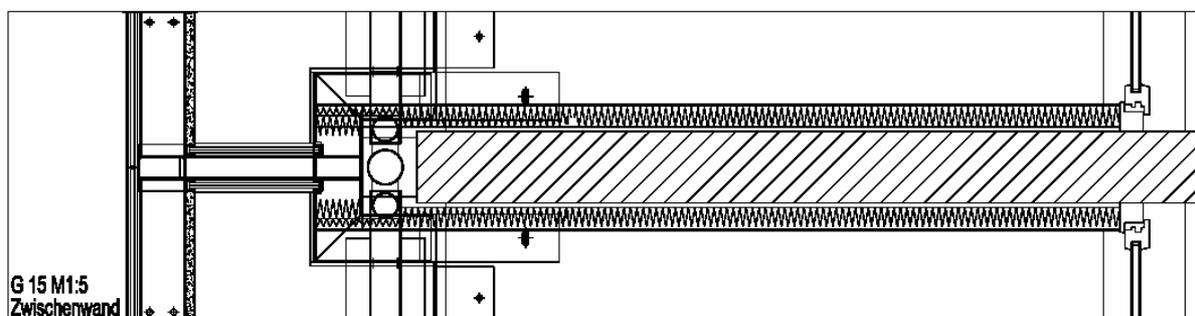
Detail G 15 Horizontalschnitt Balkonzwischenwand
